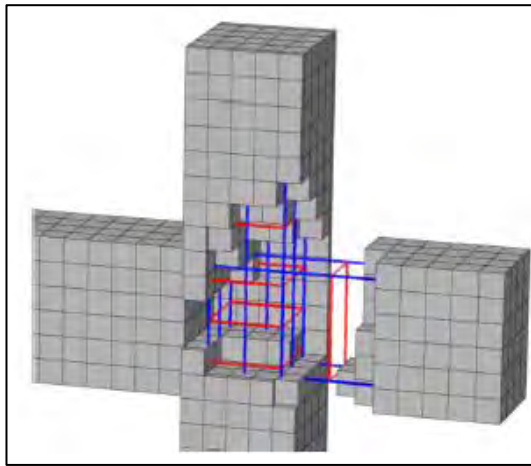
12 Discretización de elementos finitos del pórtico de concreto armado (Fuente: Alouzi et al, 2014).
